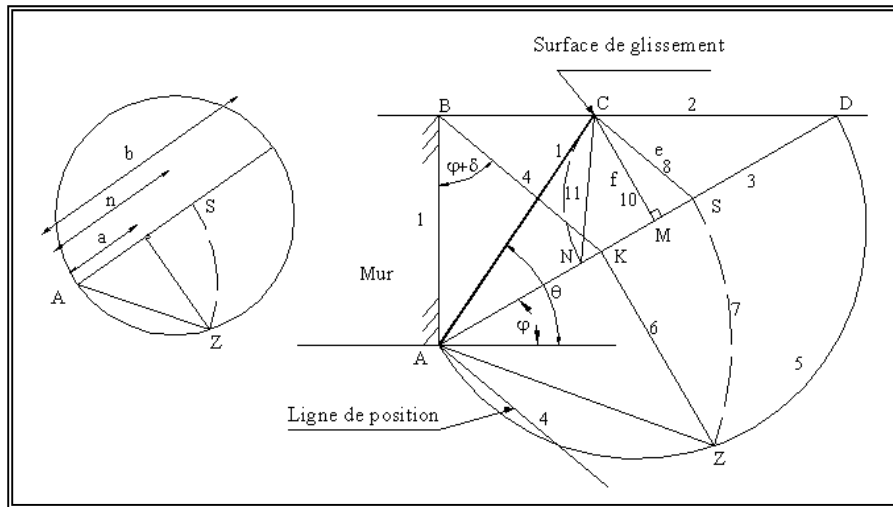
La construction graphique de Poncelet au cas de la poussée.
